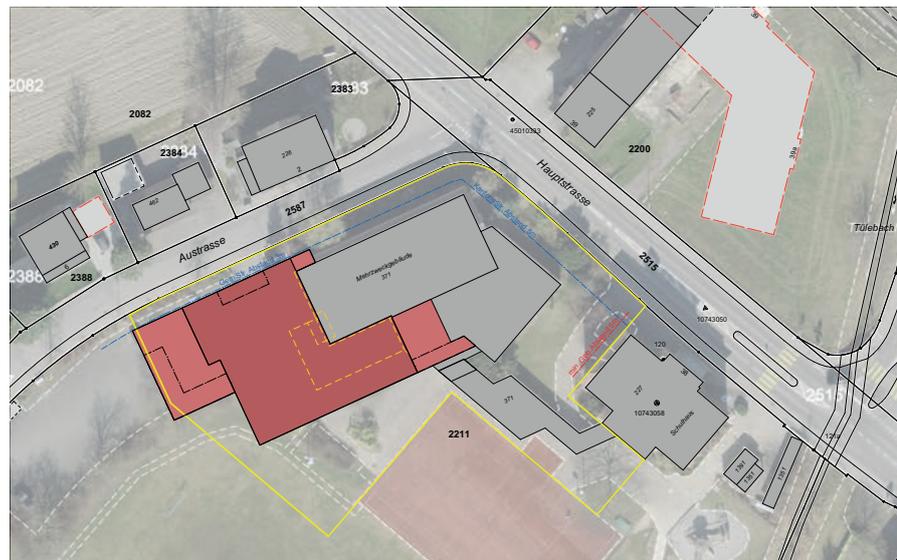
Situation, Grobdispo - Variante 1, 9.4.25 (Hinweis: Vergrösserung siehe Planbeilage)
